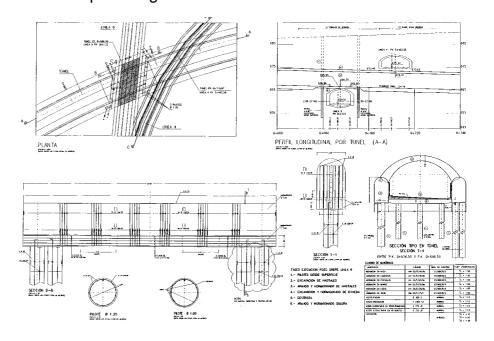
Tratamientos en el cruce con la línea 9. Detalle del armado del hastial apoyado sobre pilotes de diámetro 1.25m puenteando la línea 9 de Metro.
